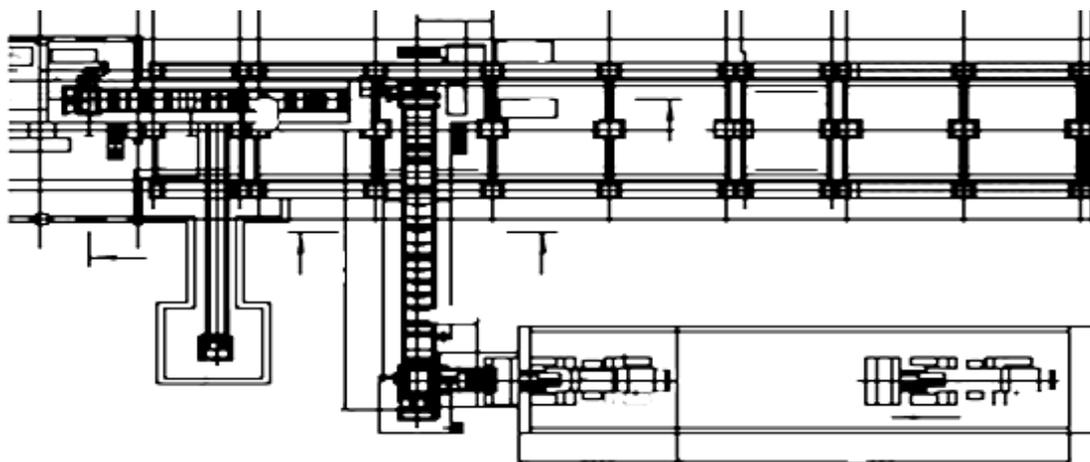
Схема подачи в аглошихту конвертерного шлака
